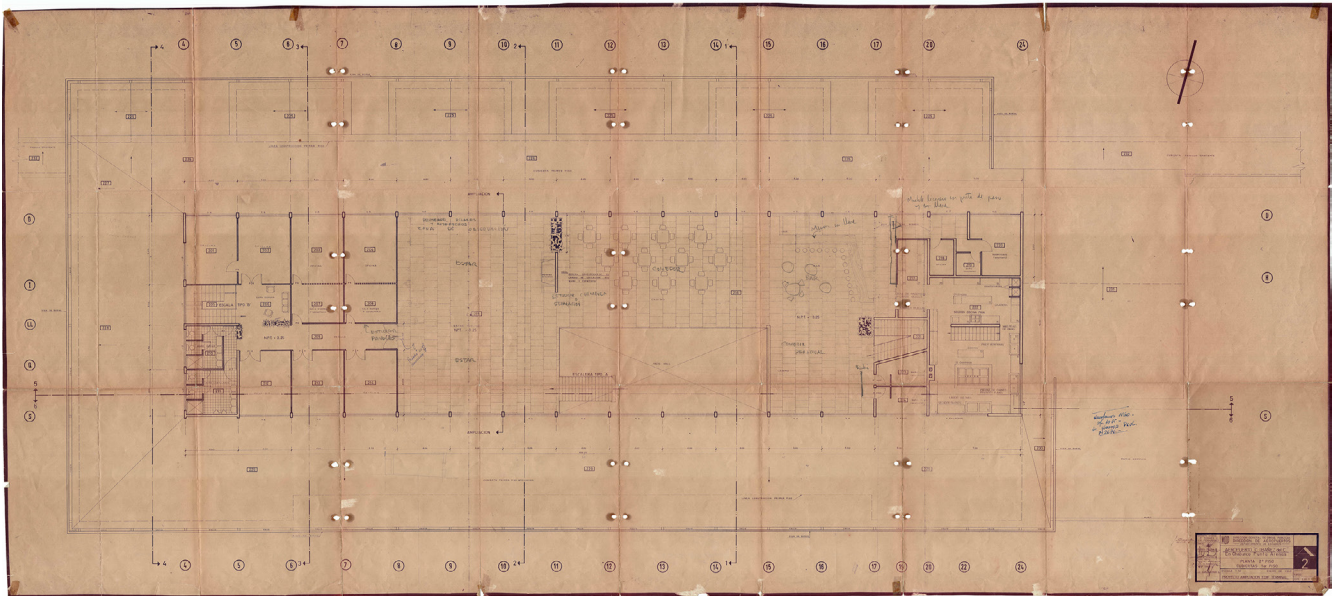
Planta 2º piso y cubiertas 1er piso (fuente: Ministerio de Obras Públicas, 1968).
